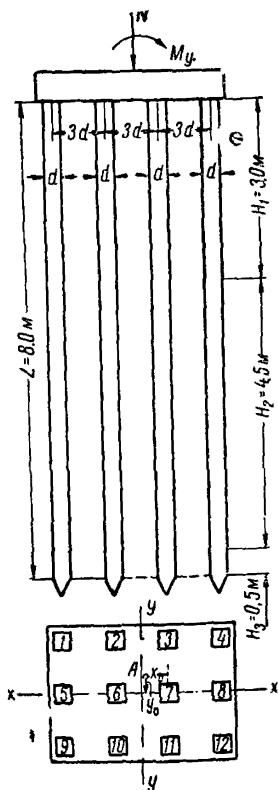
План и поперечный разрез свайного фундамента (к примеру 6)
